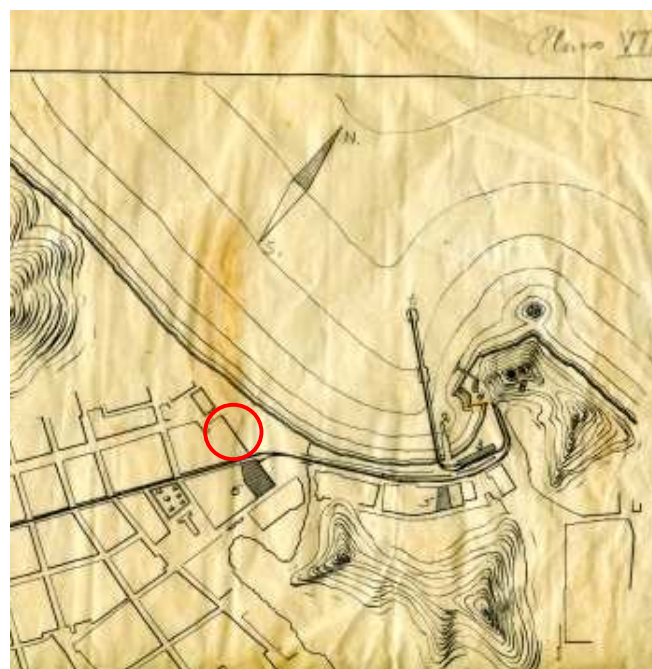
Detalle. “The Cumaná and Carúpano Puer and Tramway Company”. Plano de Carúpano (Fuente: Biblioteca Nacional).
